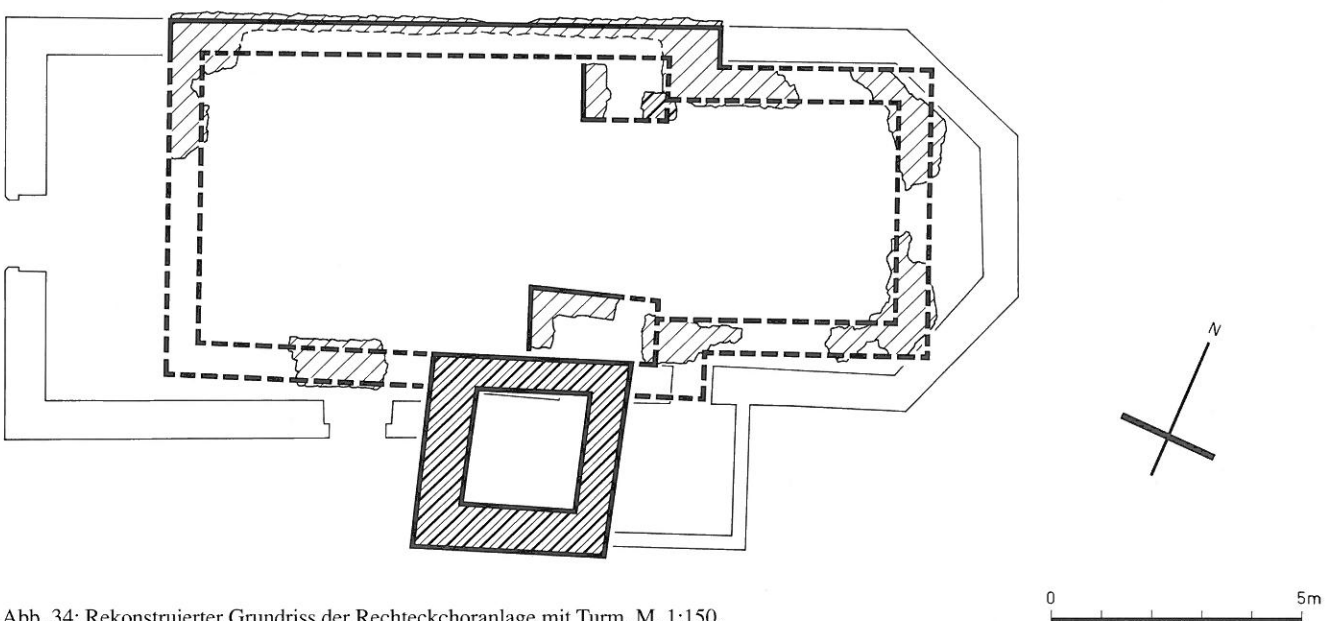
Rekonstruierter Grundriss der Rechteckchoranlage mit Turm. M. 1:150.
